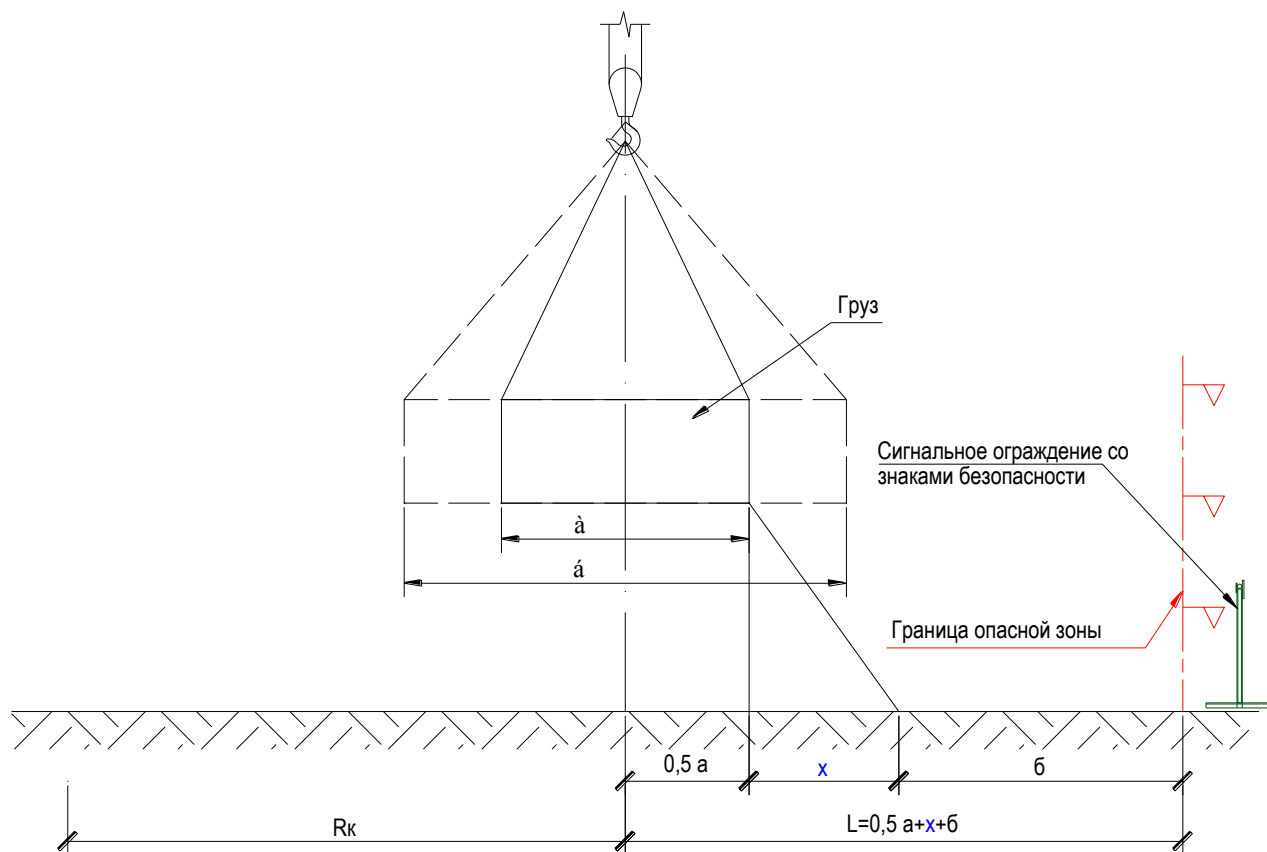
Определение опасной зоны падения груза при его перемещении краном.
